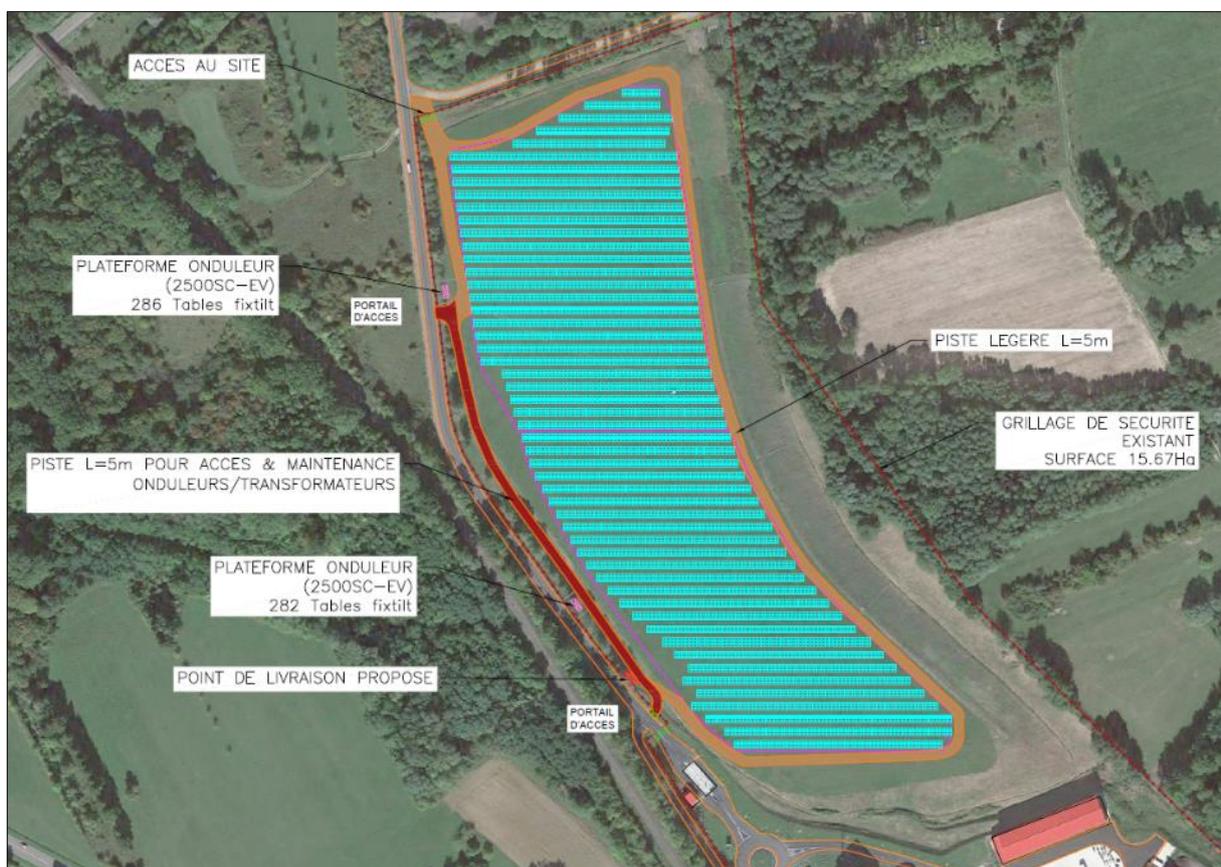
Schéma d'implantation de la centrale comprenant la position des installations vis à vis des pistes
